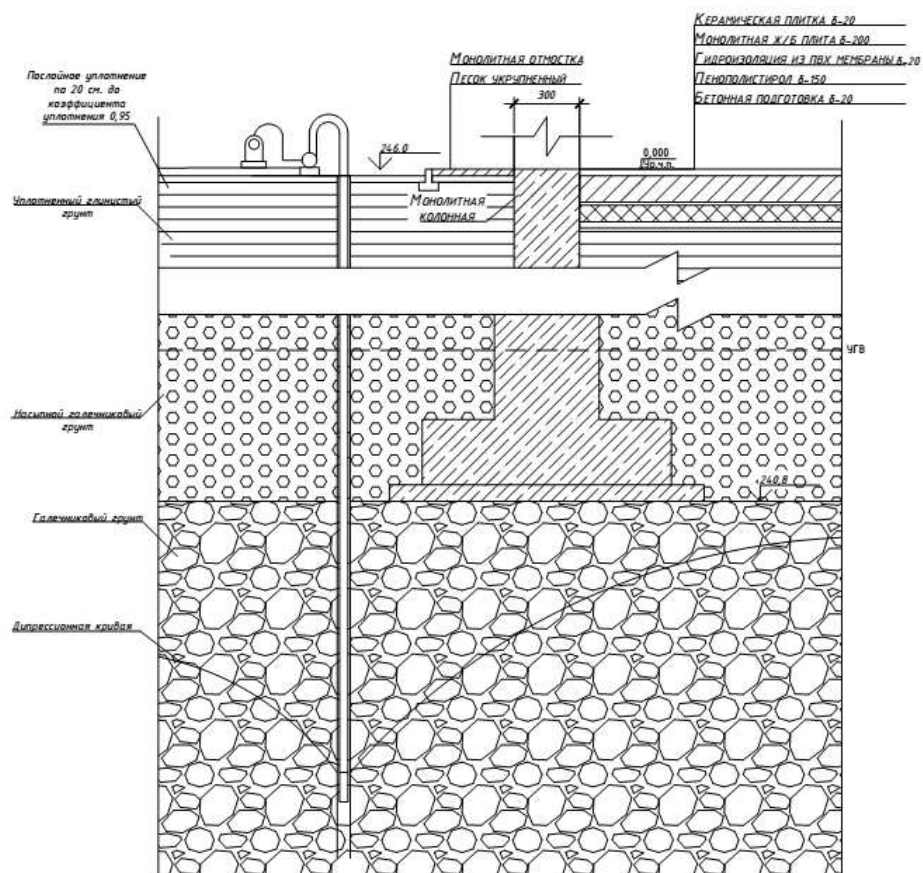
Инженерно-геотехнический разрез столбчатого фундамента
